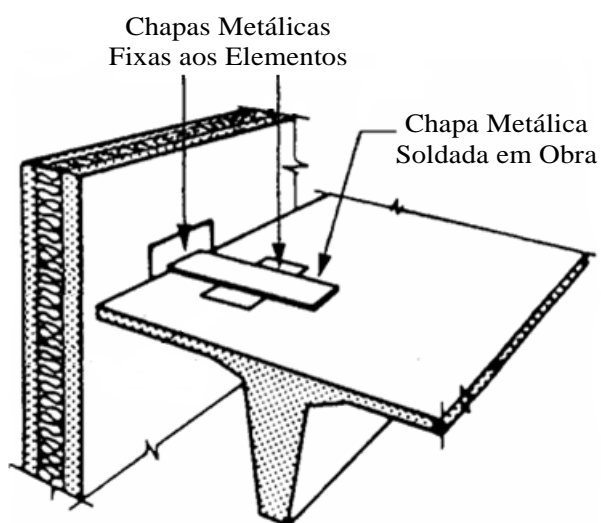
Ligação painel sandwich - laje nervurada em T por soldadura, adaptado de [32]
